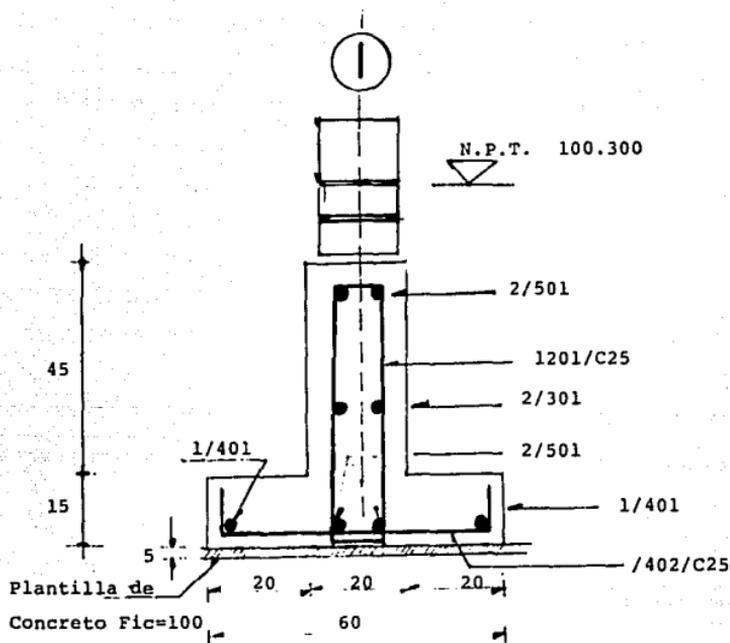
Croquis Tipo de Desplante de Cimentación.
